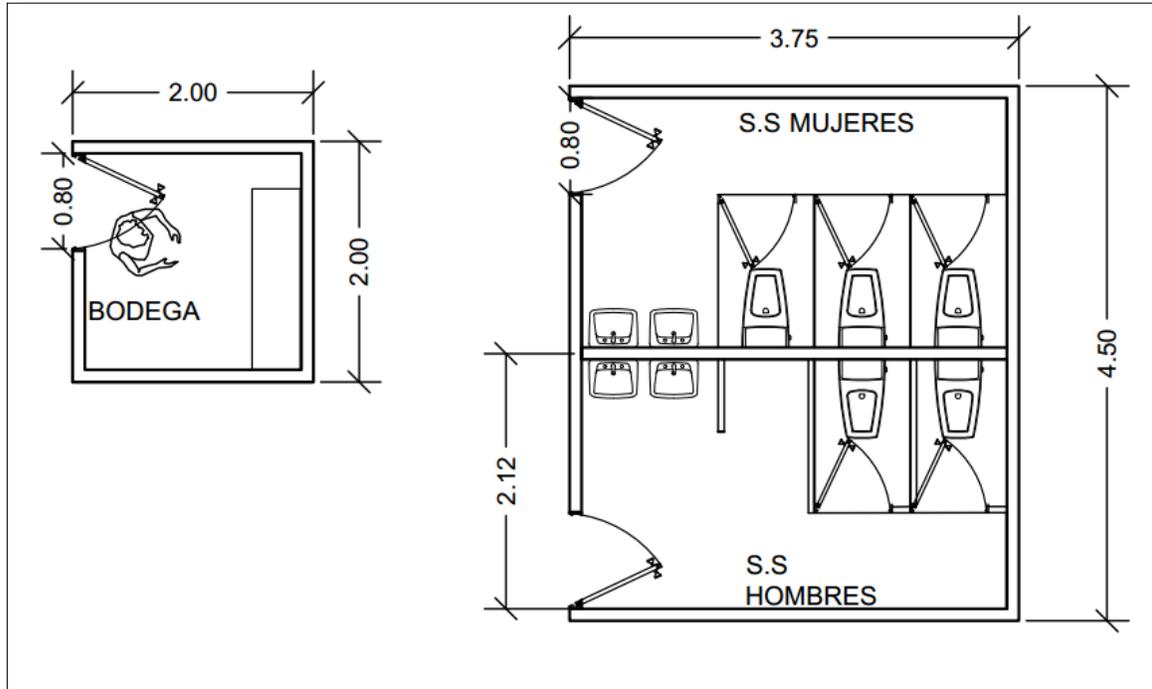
propuesta distribución en planta bodega y servicios sanitarios SIN ESCALA
